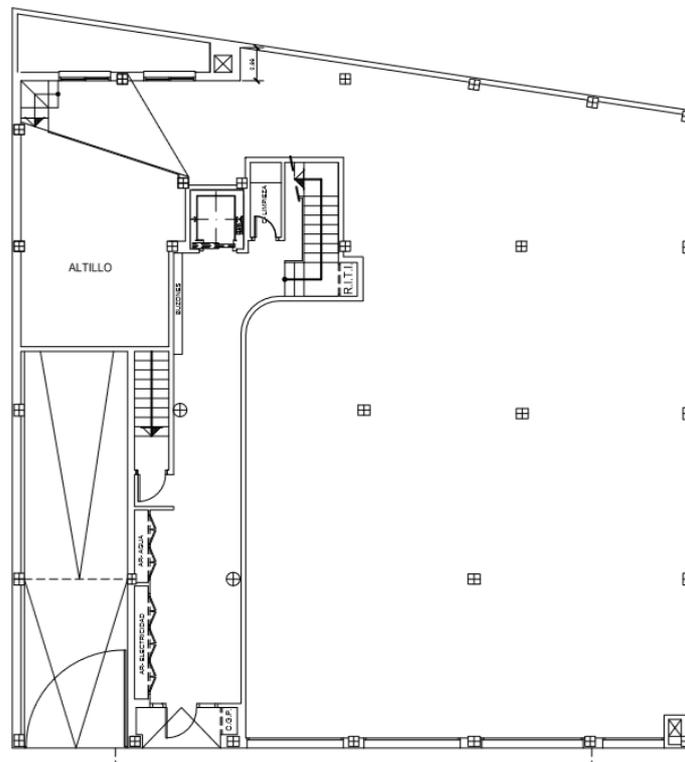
Planta Baja Edificio Pla de l'Arc, 2010.
